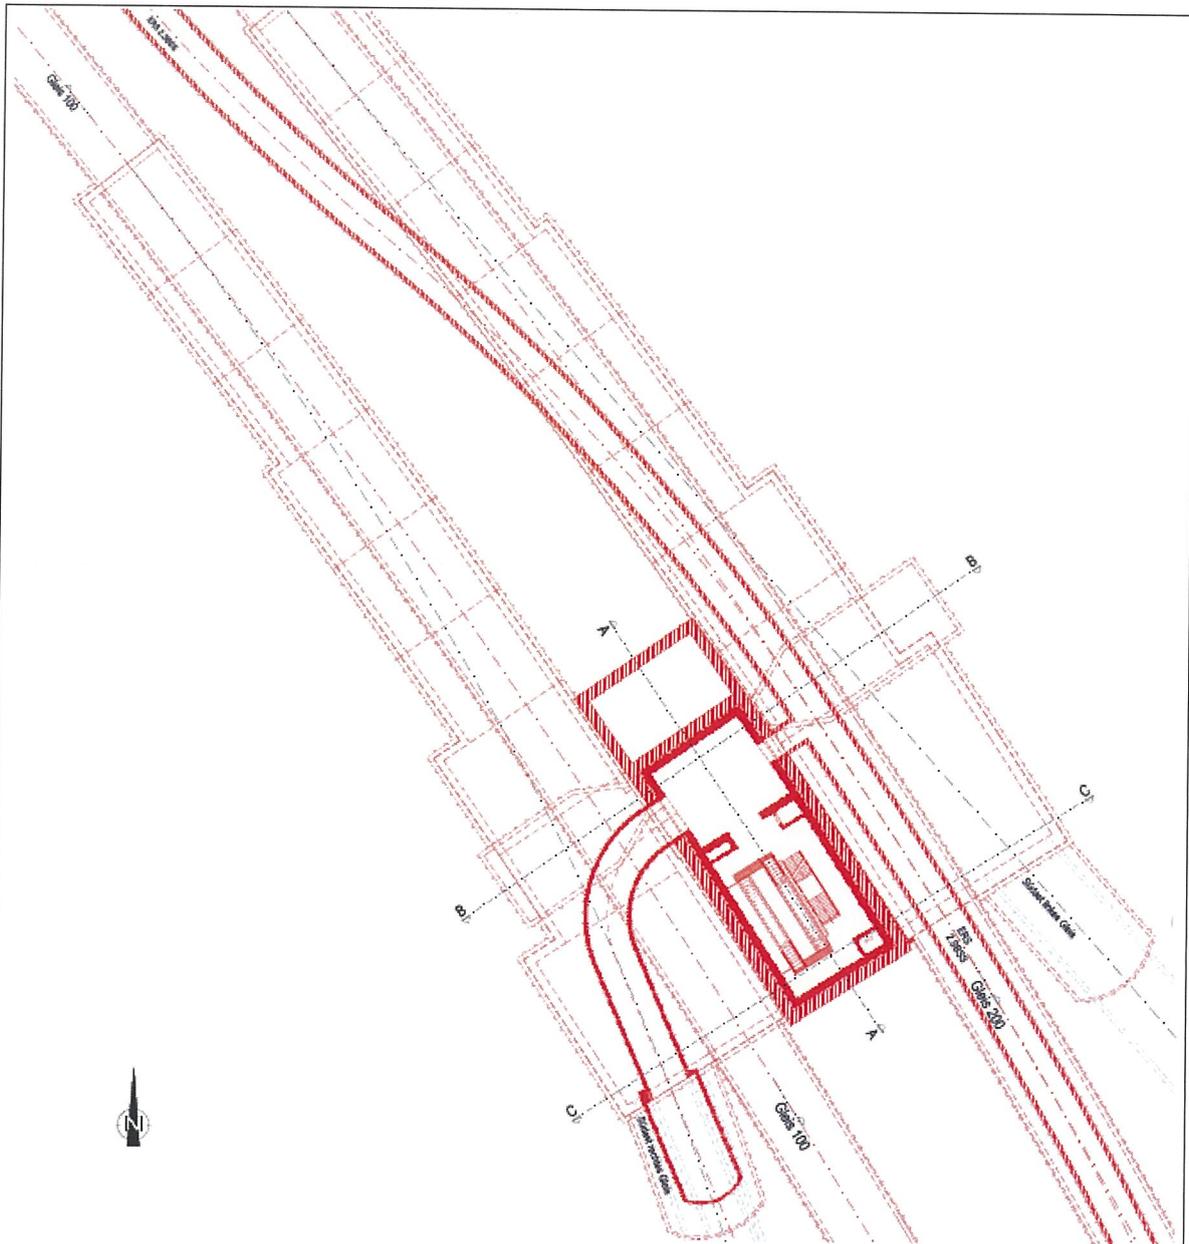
Rettungsschacht Nr. 7 mit Fahrtreppen und Festtreppe (Grundriss Ebene -5 mit Anschlüssen der Erkundungs- und Rettungsstollen der 2. SBSS und des Südabzweigs, Prinzip)
